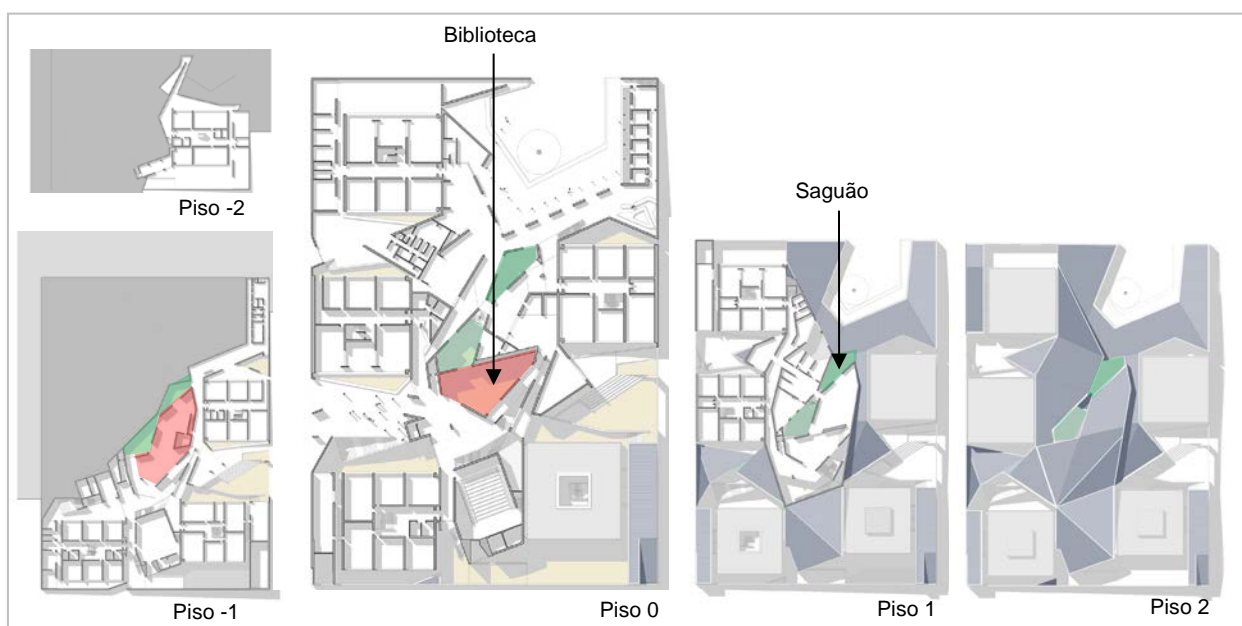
Plantas da Escola Secundaria de Caneças
